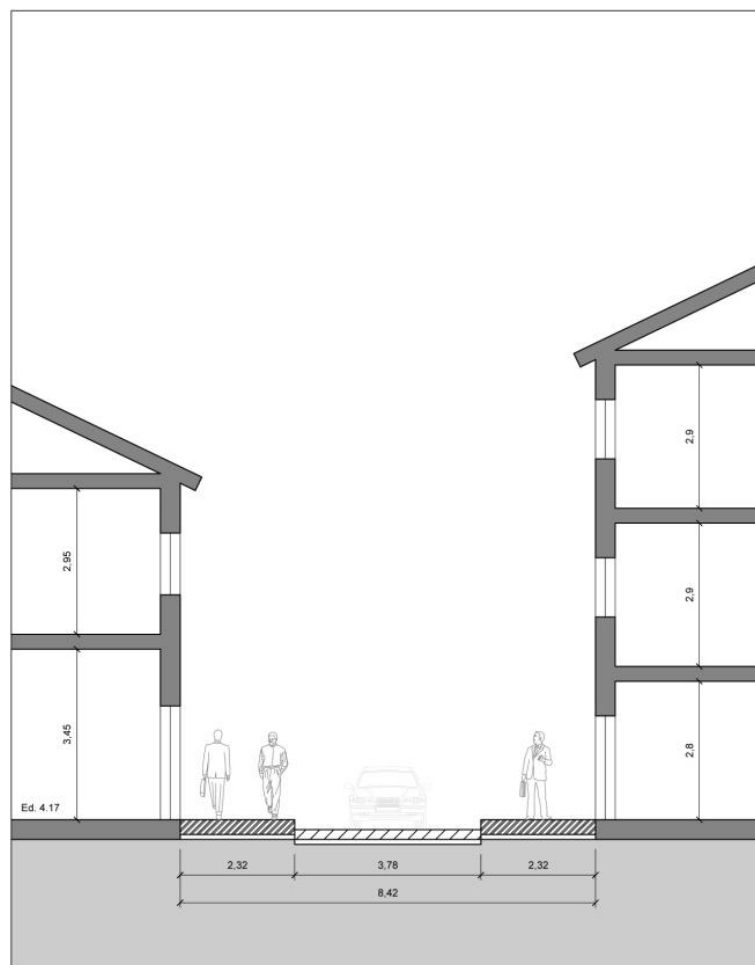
Perfil tipo de arruamento viário existente (Rua de Stº António) (anexo a.13)
